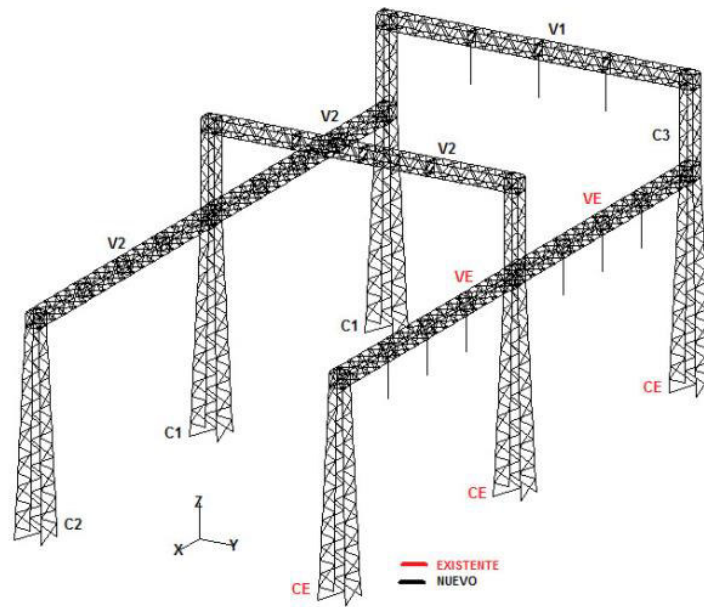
Modelo estructural Pórtico 1 – 220 kV
